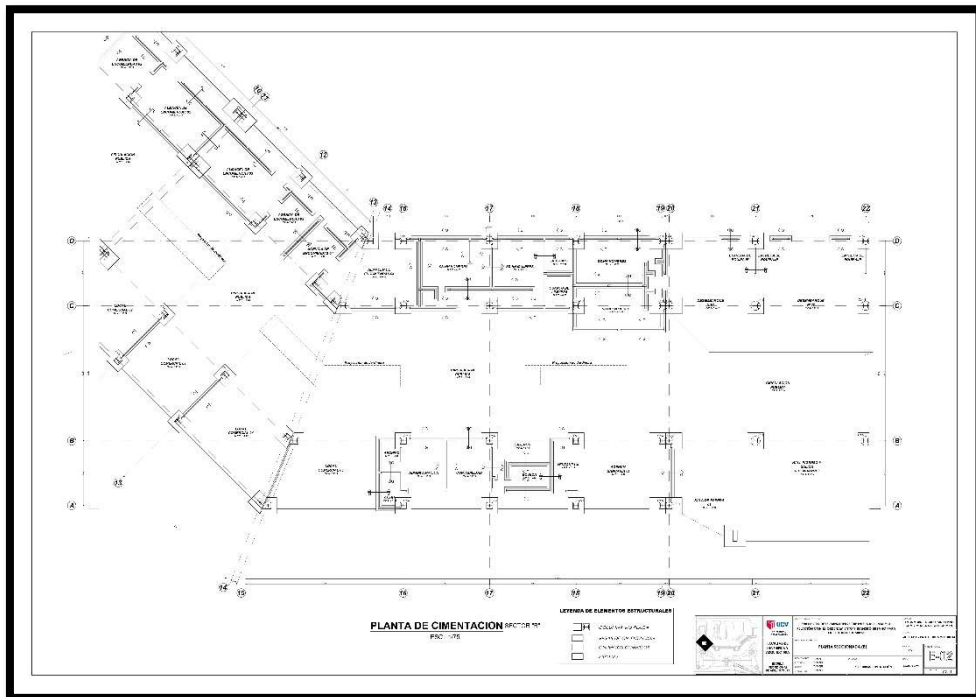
Plano de Cimentación Sector (B) Fuente: Elaboración Propia.
